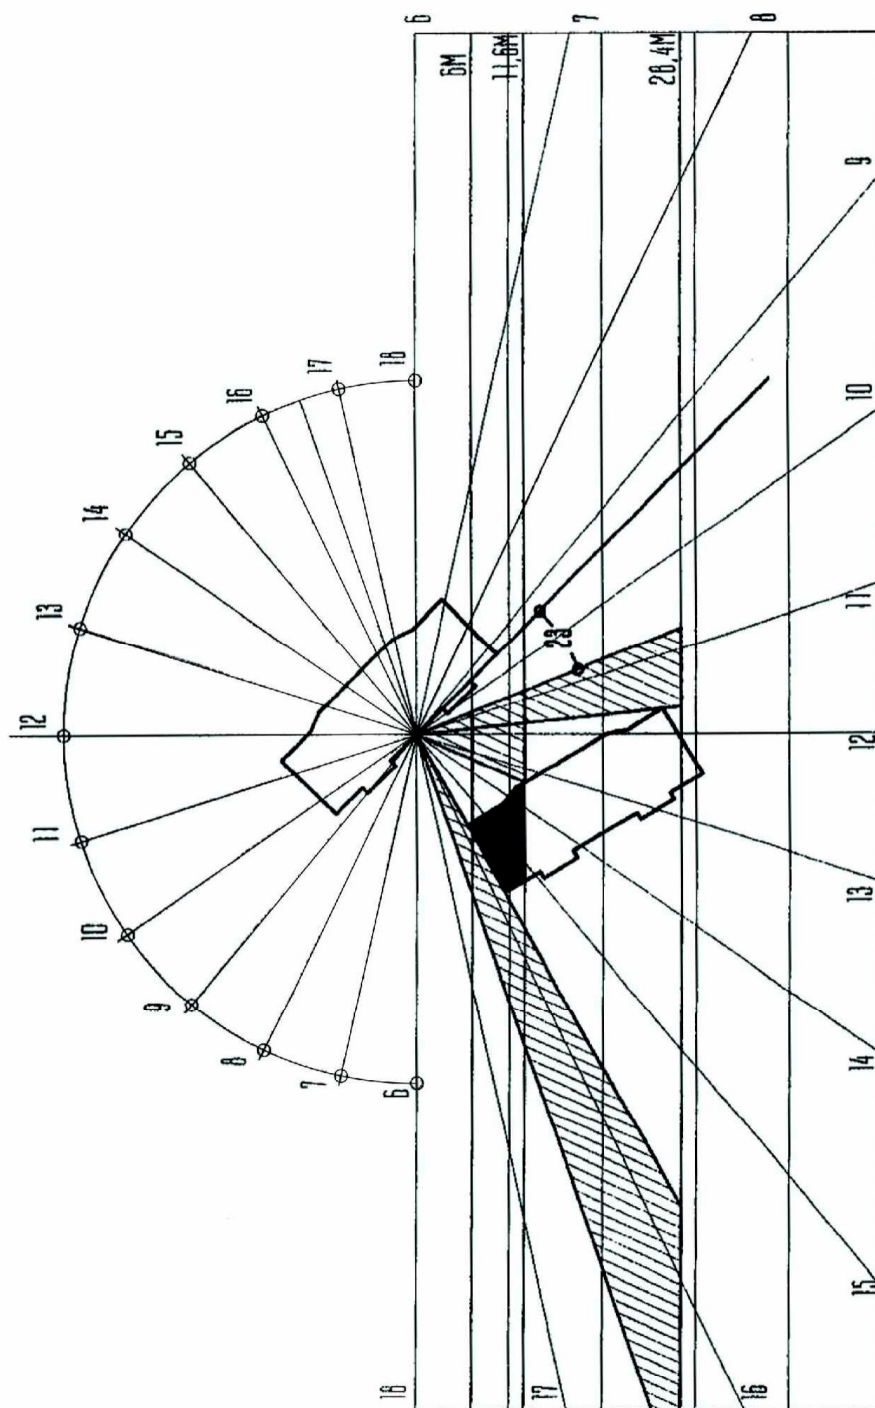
Расчет времени инсоляции точки фасада на уровне 6-го этажа с учетом затеняющего здания
